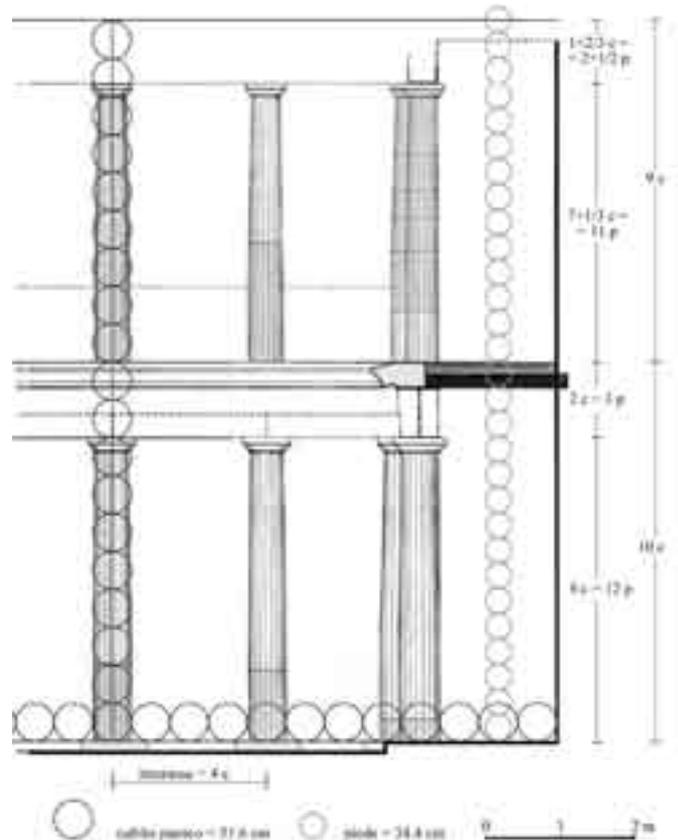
Palermo, cortile di Palazzo Sclafani. Sezione integrata con ricostruzione dell'angolo nord-est del peristilio, prima fase. Analisi modulare degli elementi.
